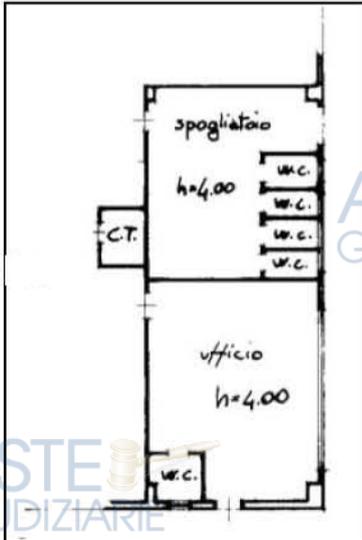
Lotto 3 – Stralcio della planimetria catastale uffici interni al capannone, piano terra sub. 3.
